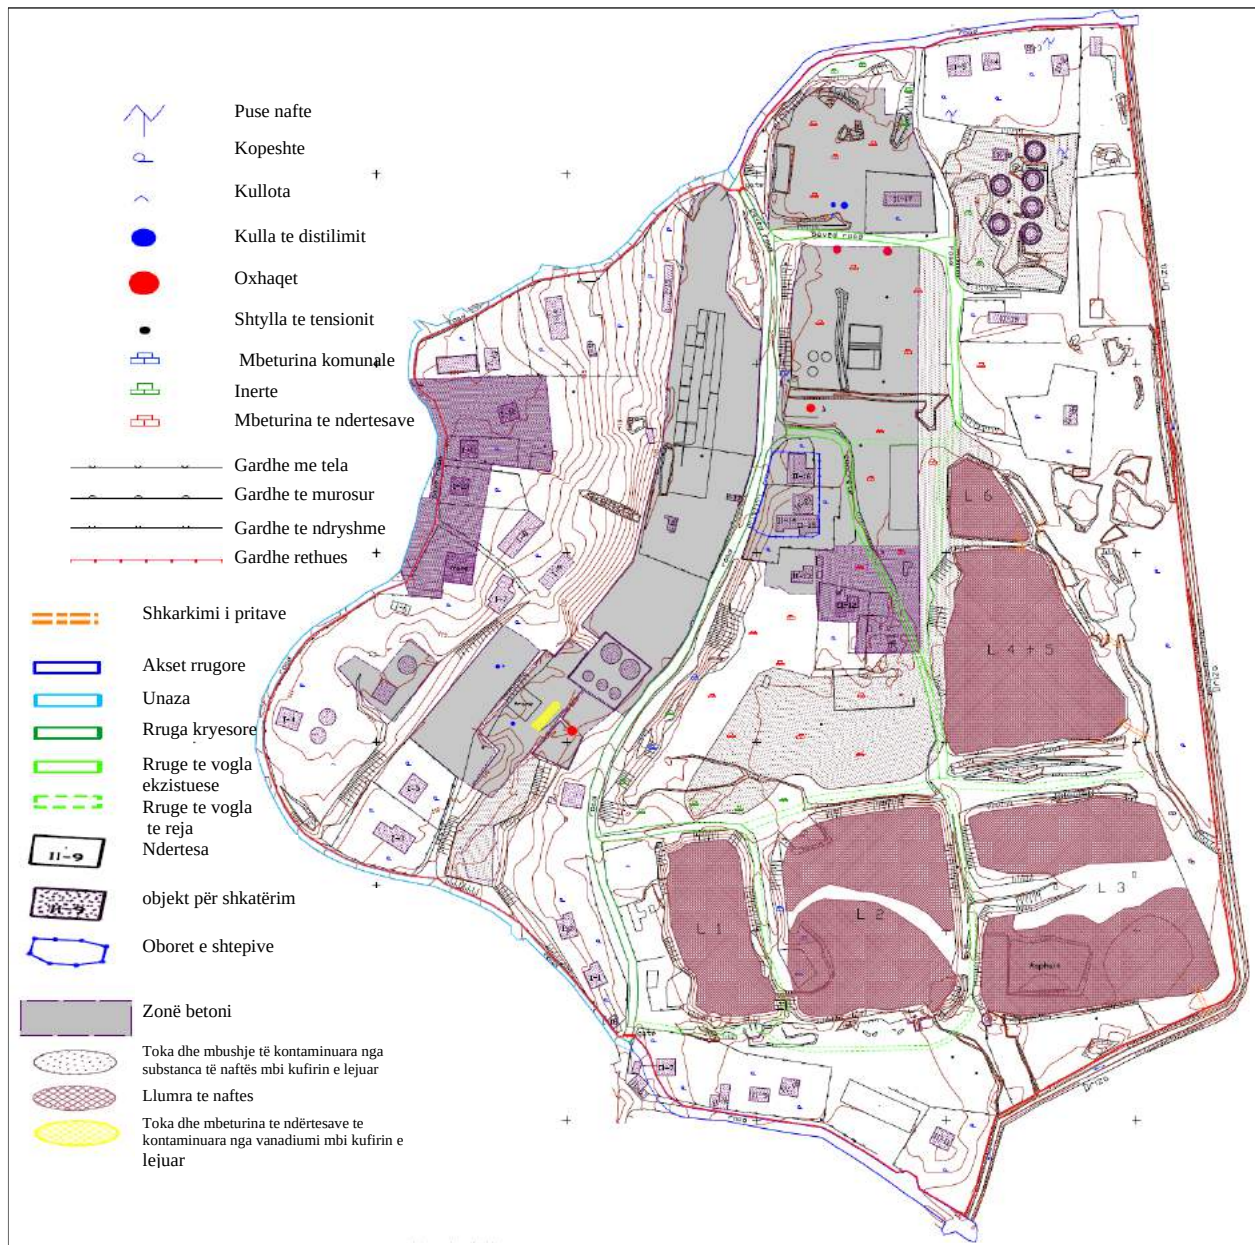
Planimetria e ish-rafinerisë së naftës në Kuçovë
